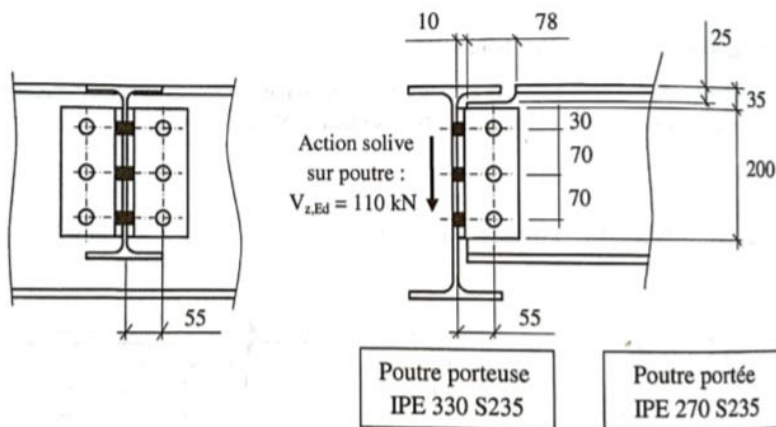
Assemblage avec boulon (poutre-solive)
